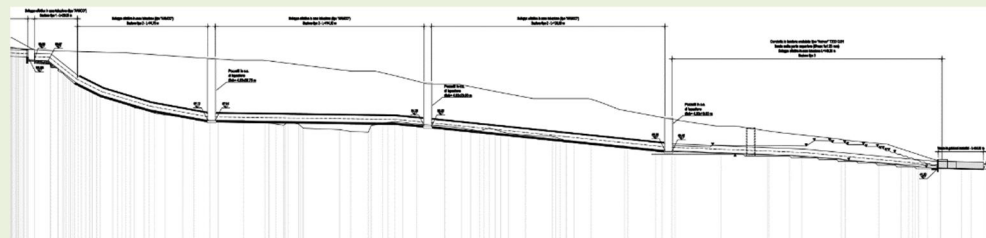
Profilo tubazione provvisoria in fase di cantiere posata lungo l'alveo esistente
